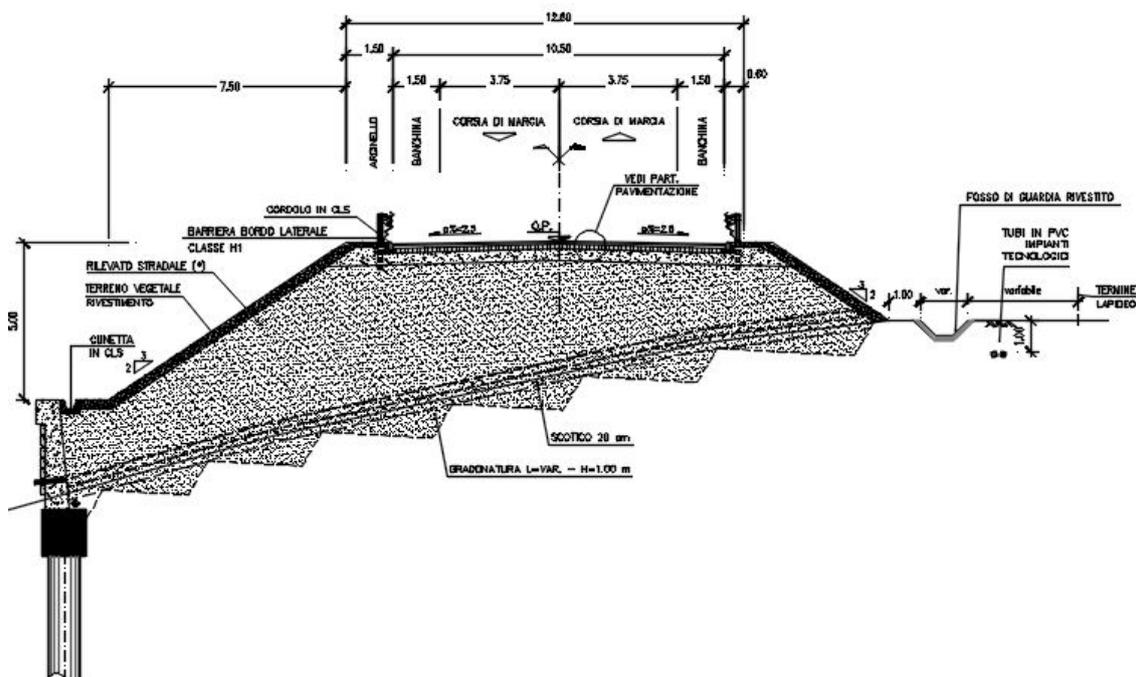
Sezione tipo in rilevato asse principale con intervento di gradonatura
